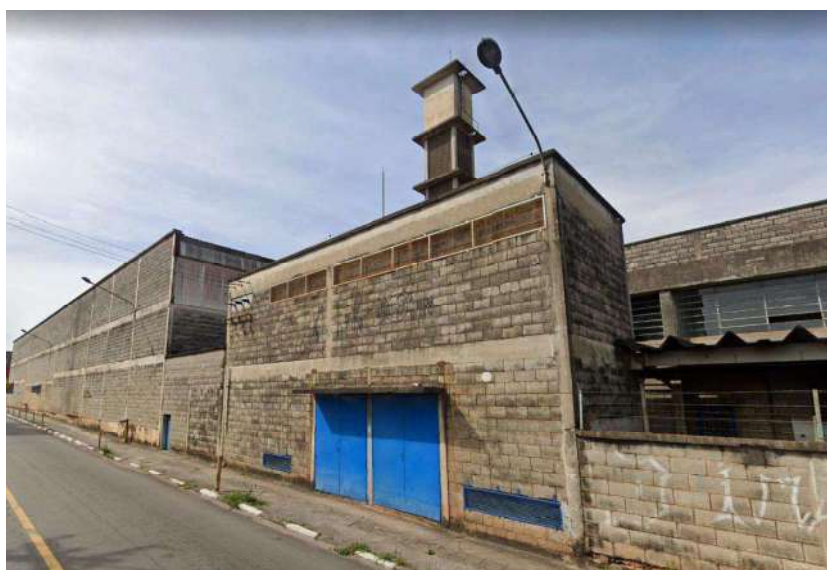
Vista da entrada principal - Av. David Kasitzki, 135
